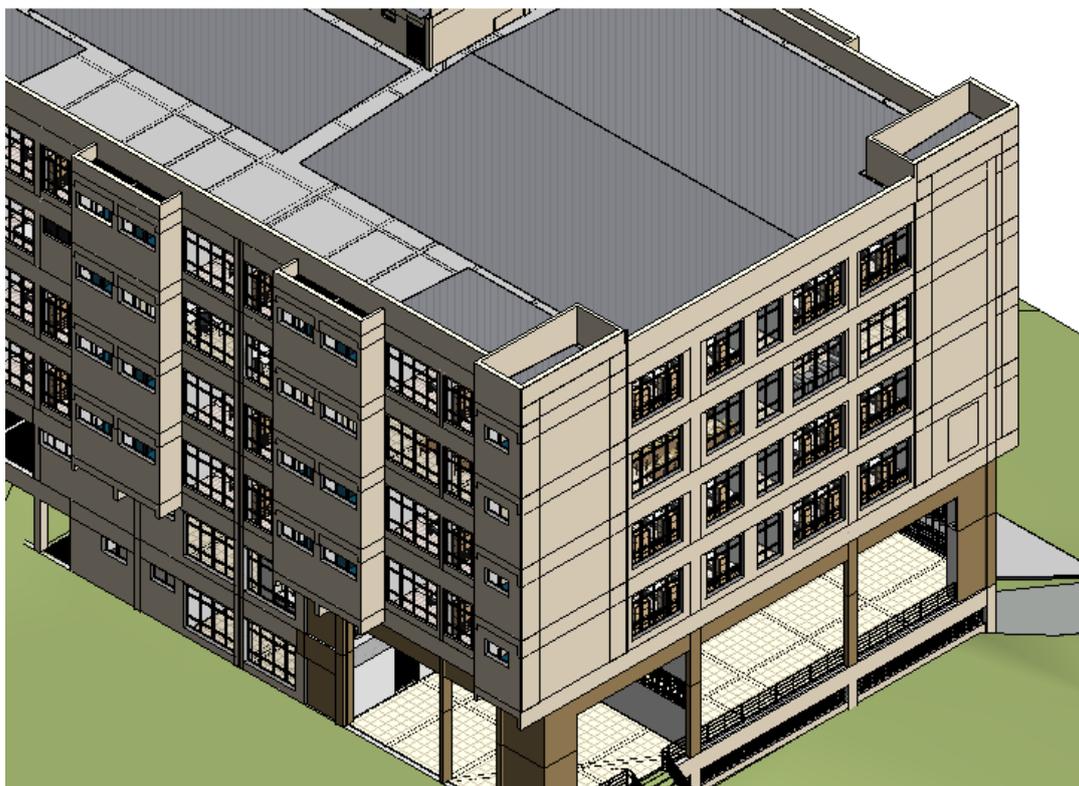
Vista da fachada do prédio com as modificações propostas.
